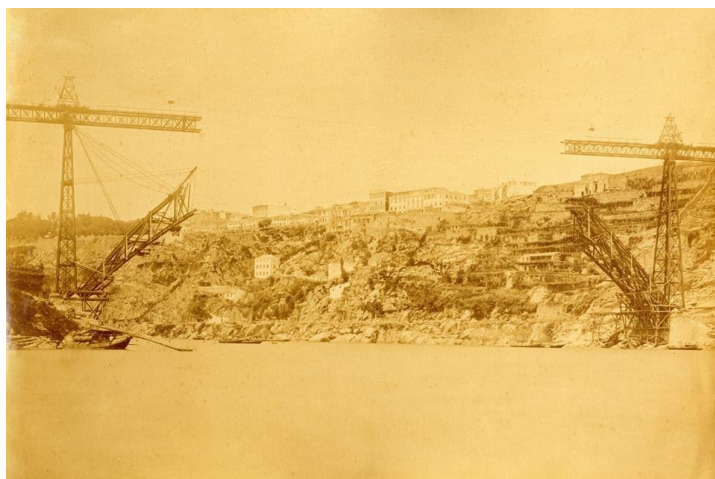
Construção da Ponte Maria Pia, 30 de junho de 1877
